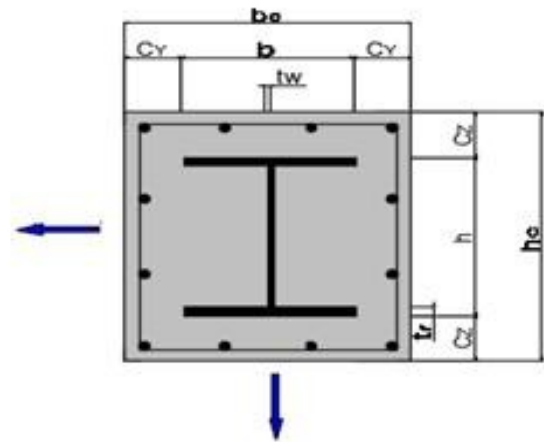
Section rectangulaire du poteau mixte totalement enrobé
